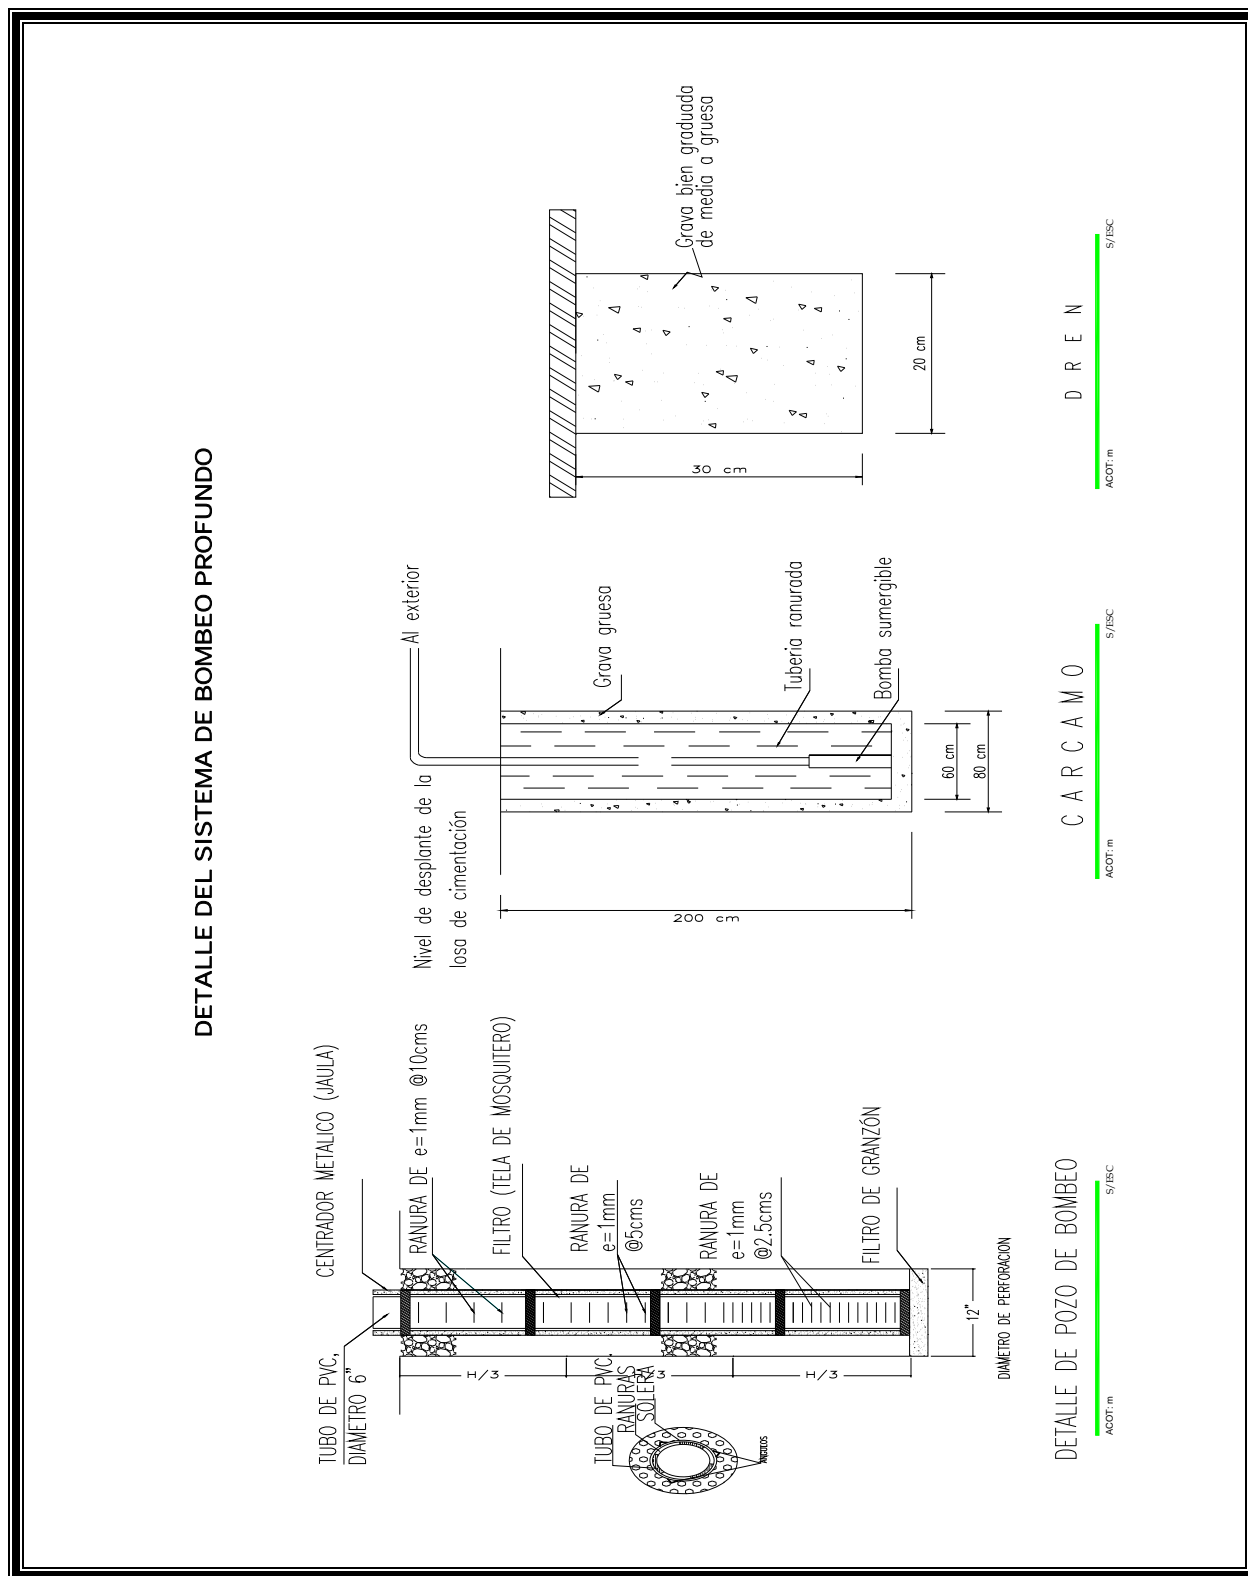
DETALLE DEL SISTEMA DE BOMBEO.
